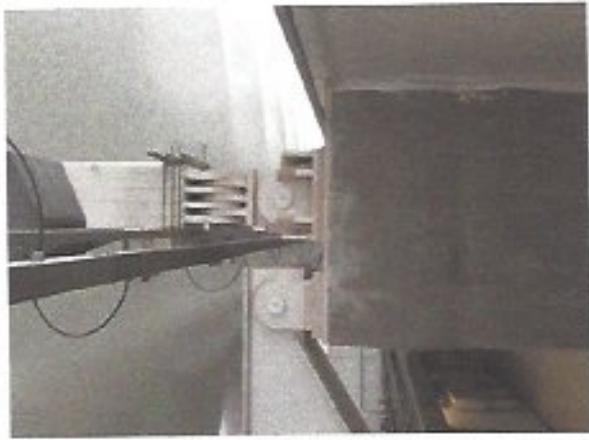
PRÉDIO OESTE – PAVIMENTO TÉCNICO
